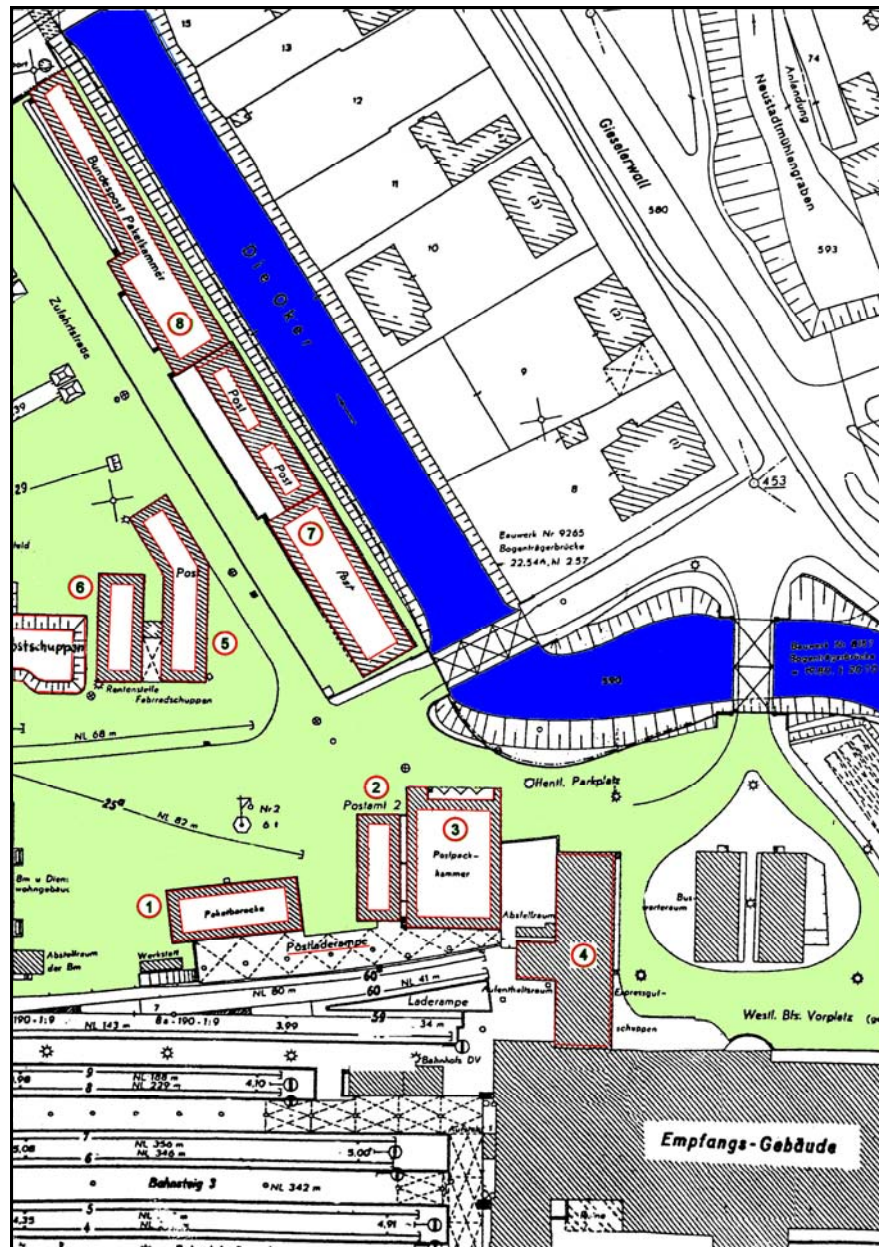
Lageplan Gebäude und Gleise am Hauptbahnhof und auf dem Holzhof von 1959
